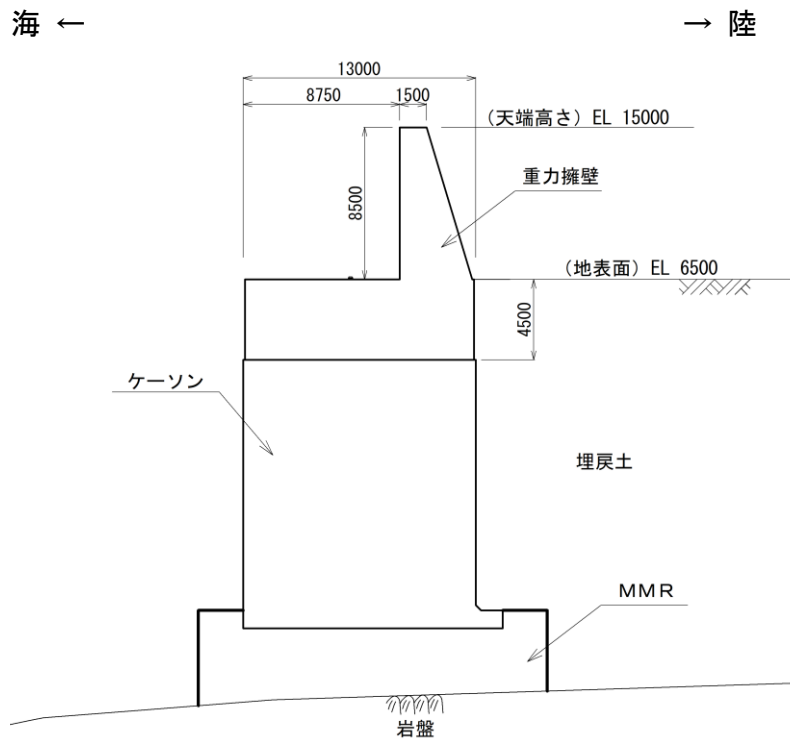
(2) 防波壁（波返重力擁壁）の構造図（断面図）（ケーソン設置部）
